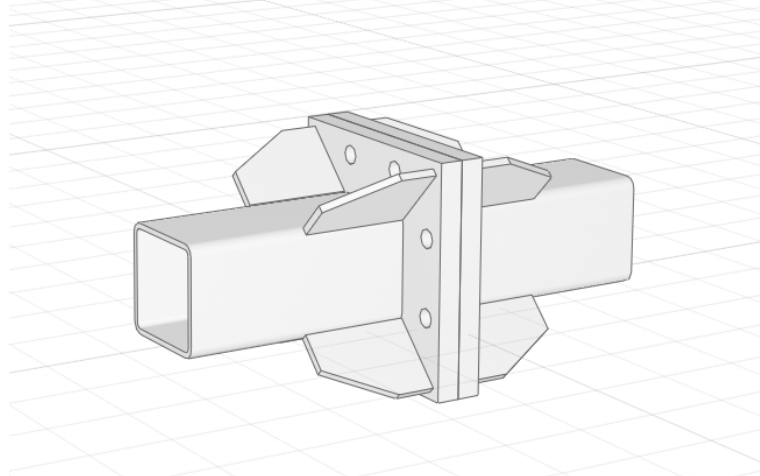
Узел сопряжения двух элементов трубного сечения фермы нижнего пояса
